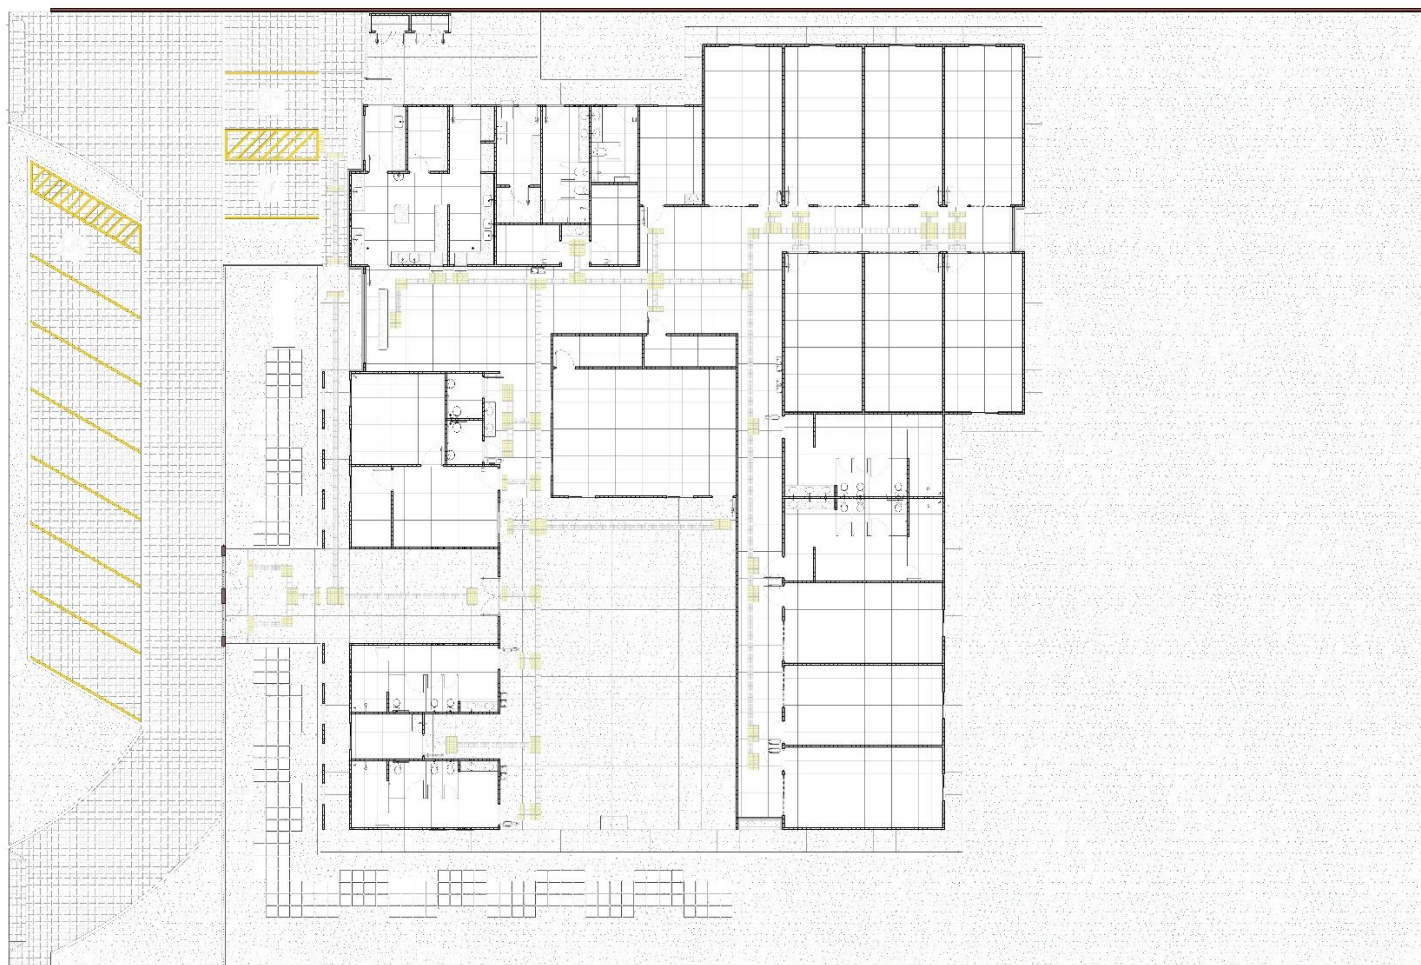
Planta Baixa de Implantação – Geral (Ampliada)
